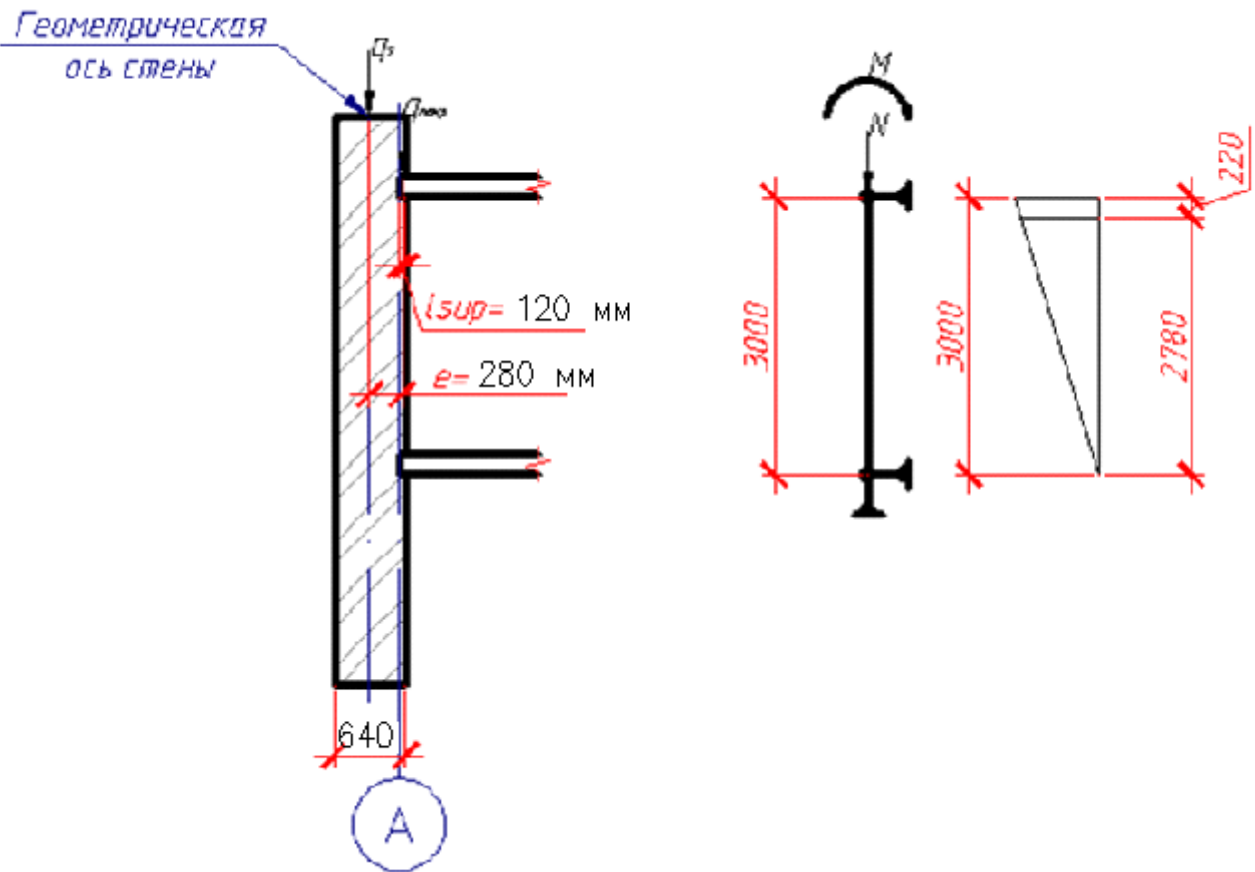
Расчетная схема простенка 1-го этажа.
